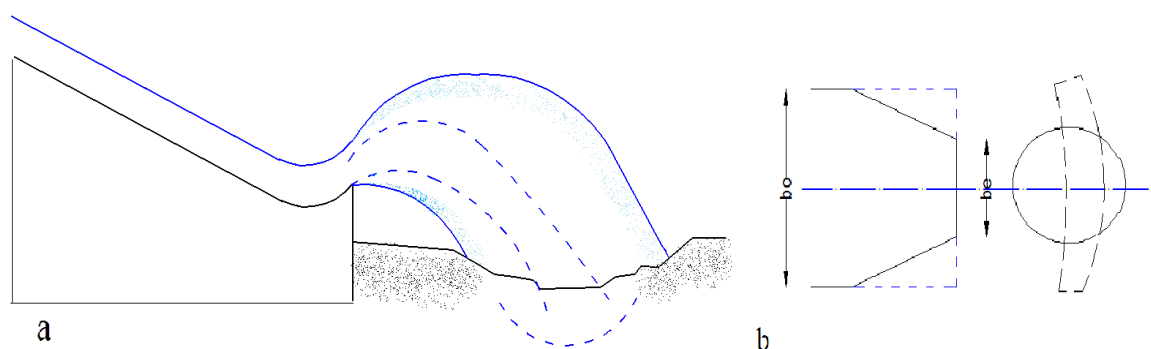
Jet tipo hendidura; (a) Vista longitudinal (b) Vista en planta
